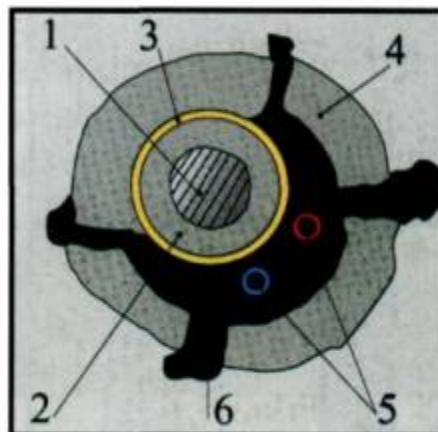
Поперечное сечение сваи «GEWI» (Dywidag)
